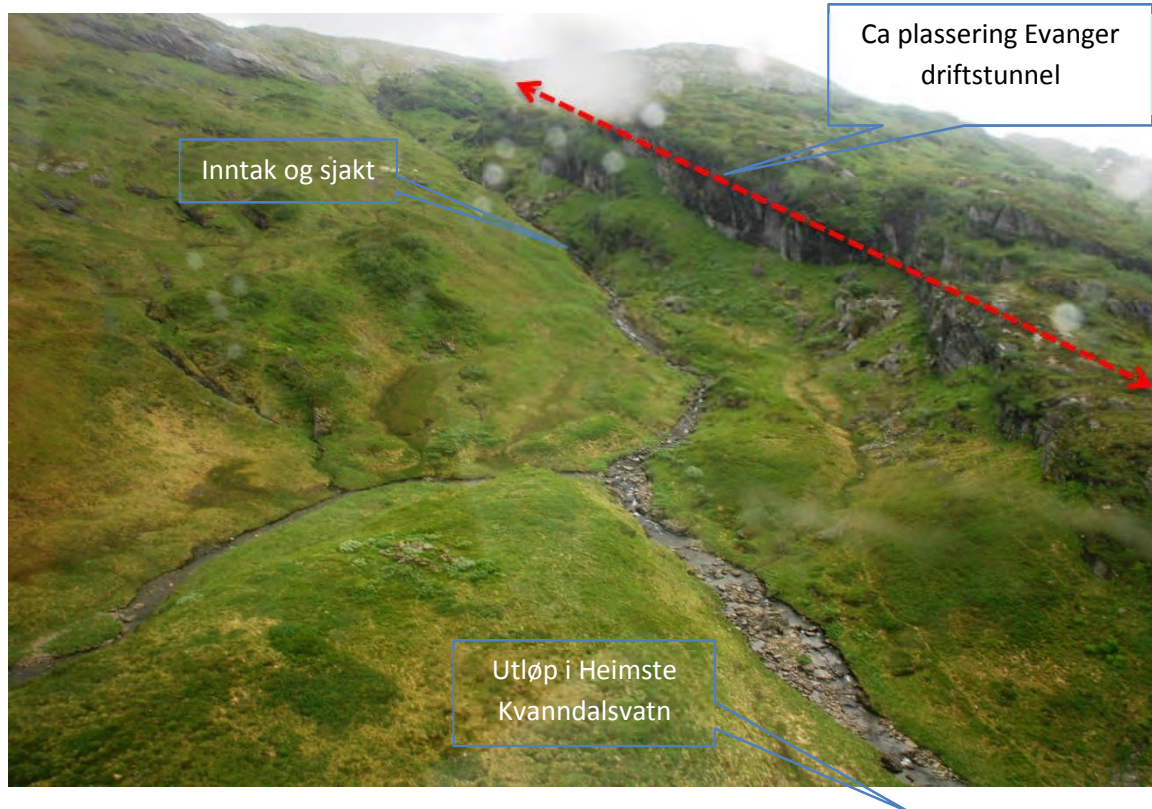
Kvanndalselvi. Inntak og tunnel mot Beinhellervatnet er planlagt like nedstrøms det øvre fallet, på venstre side.
